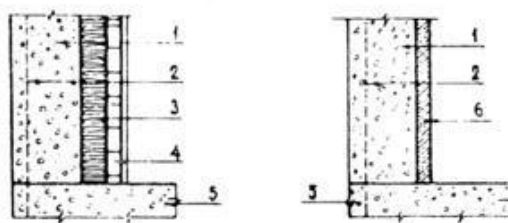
Устройство наружных стен с утеплением внутренней стороны: 1 — монолитный бетон стены; 2 — арматура; 3 — эффективный утеплитель; 4 — отделочная панель из листового материала; 5 — перекрытие; 6 — утеплитель из пористого материала объемным весом не более  $600 \text{ кг/м}^3$
